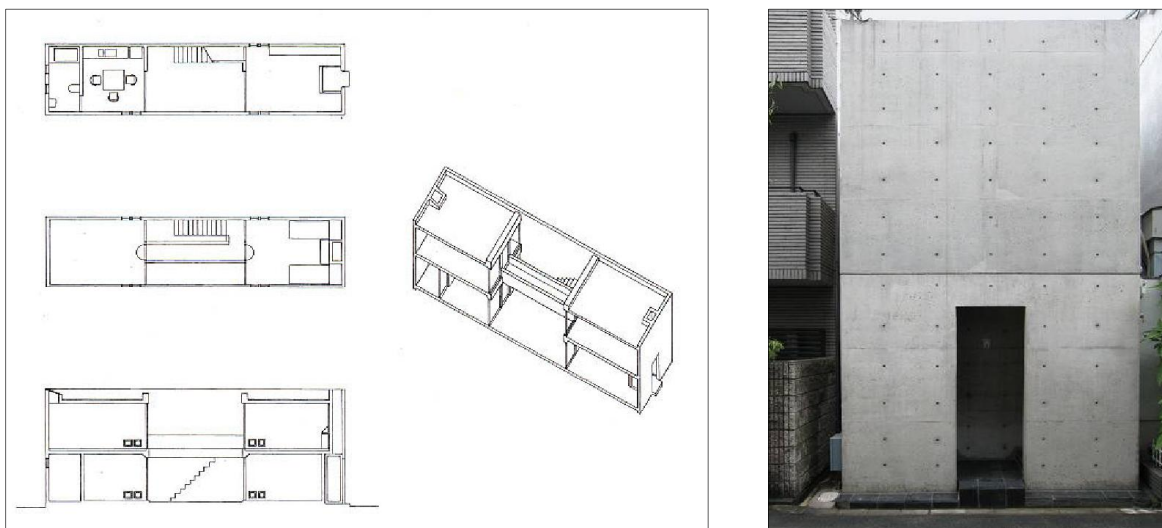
7 : Les plans, coupe et façade principale de la maison Azuma, Osaka, Japon.
